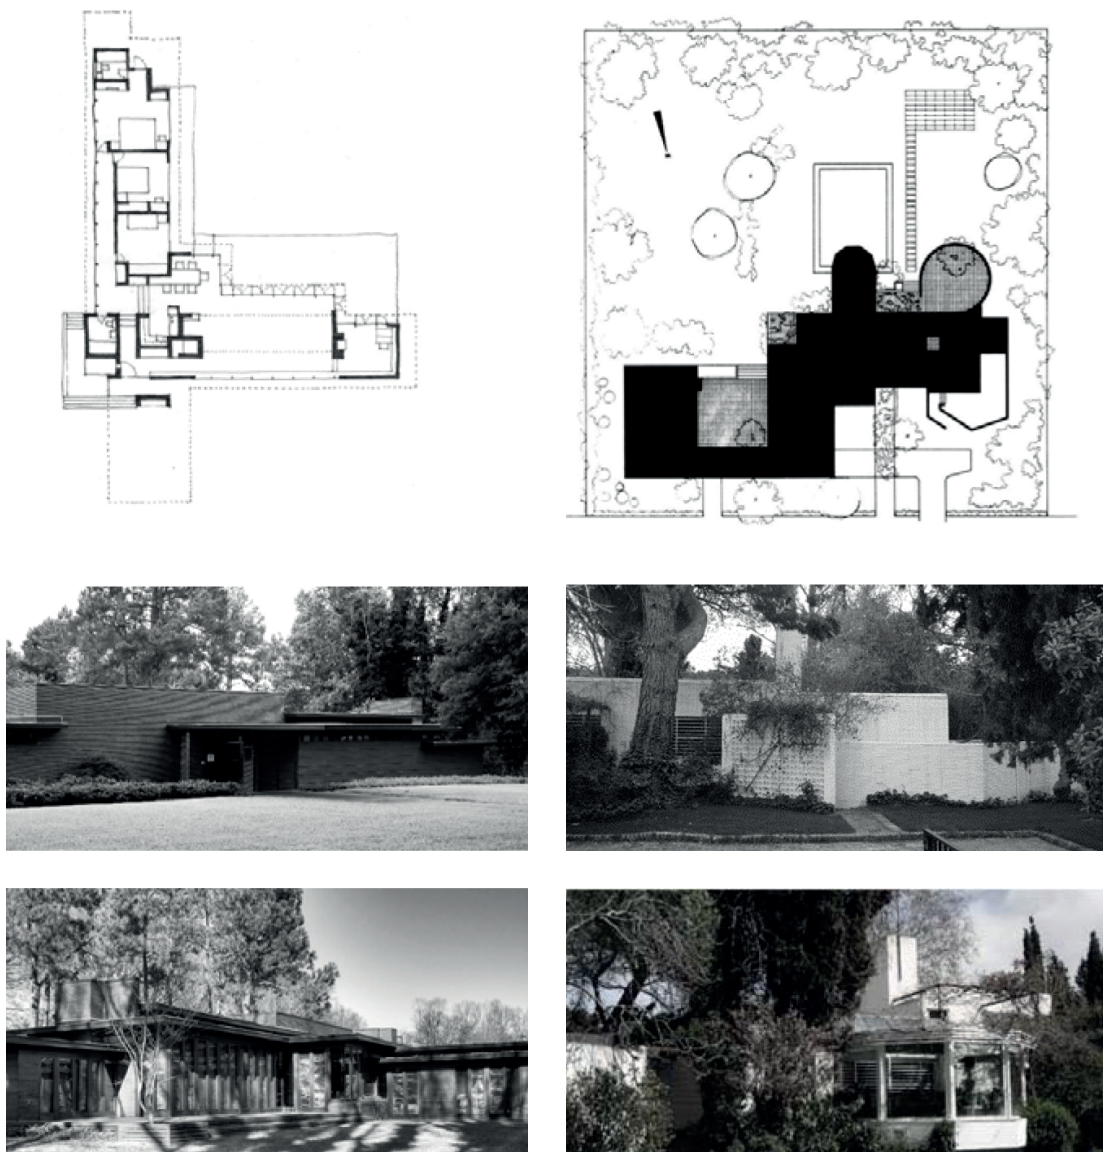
Comparativa entre la casa Rosenbaum de Wright y la casa-estudio de Julio Cano. Planta y fotos de las fachadas delantera y trasera.
